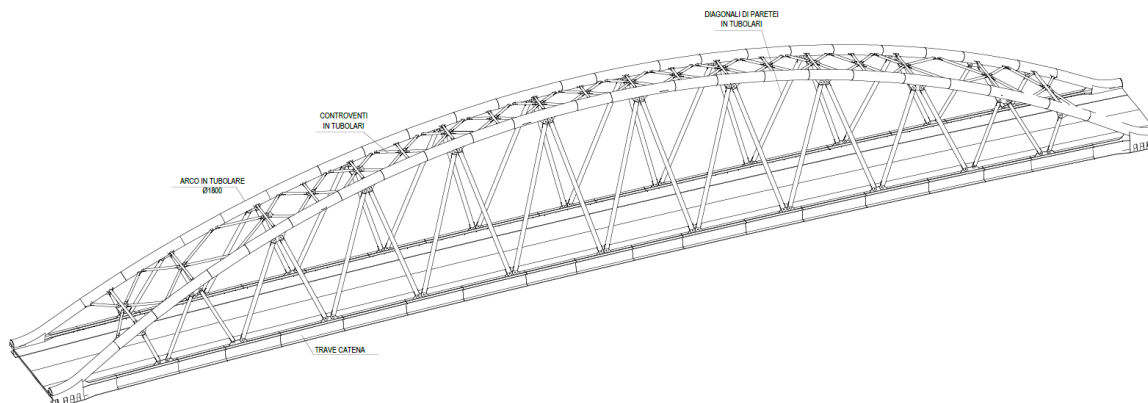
Vista assonometrica del ponte (estratto tavola 24V25_PF_T_ST_702_r00)
